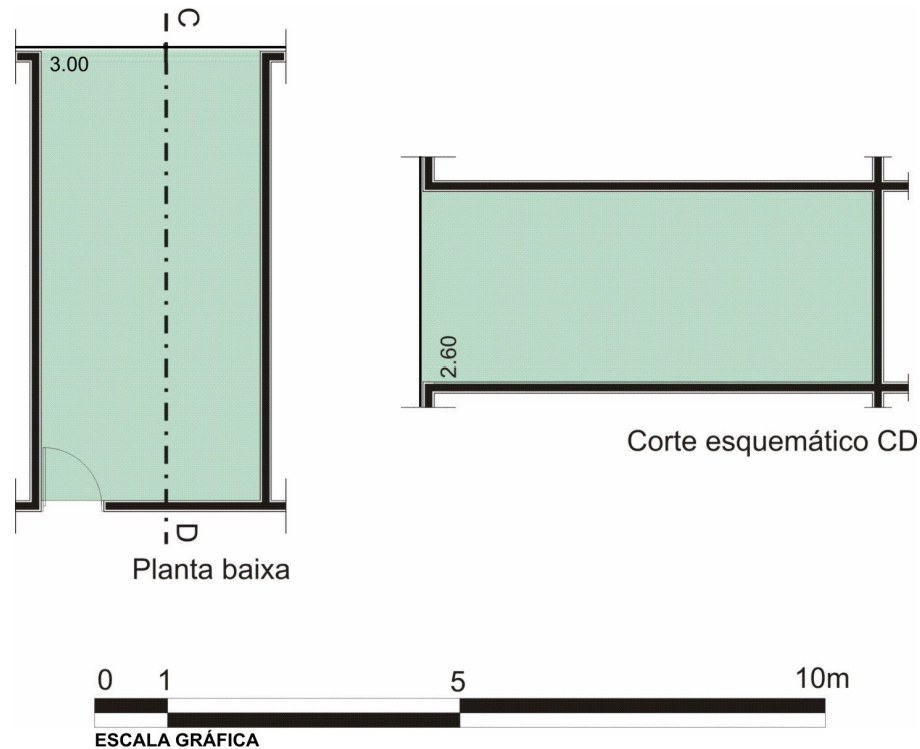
Planta baixa e corte esquemático dos módulos com tipologia de abertura:pele de vidro.
